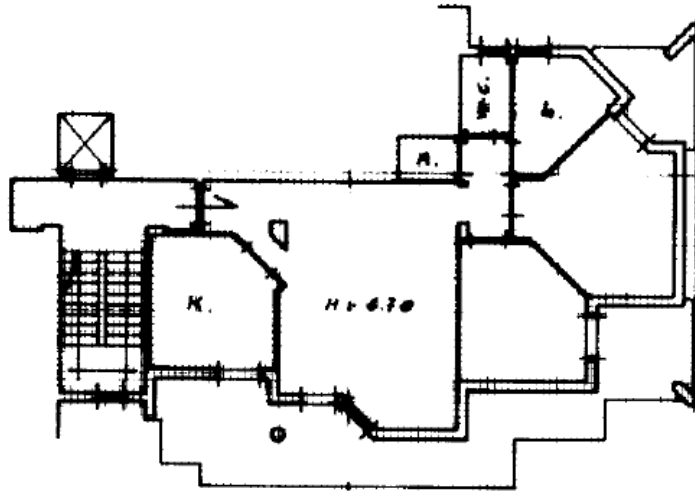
PLANIMETRIA CATASTALE – PIANO PRIMO ( in allegato)
